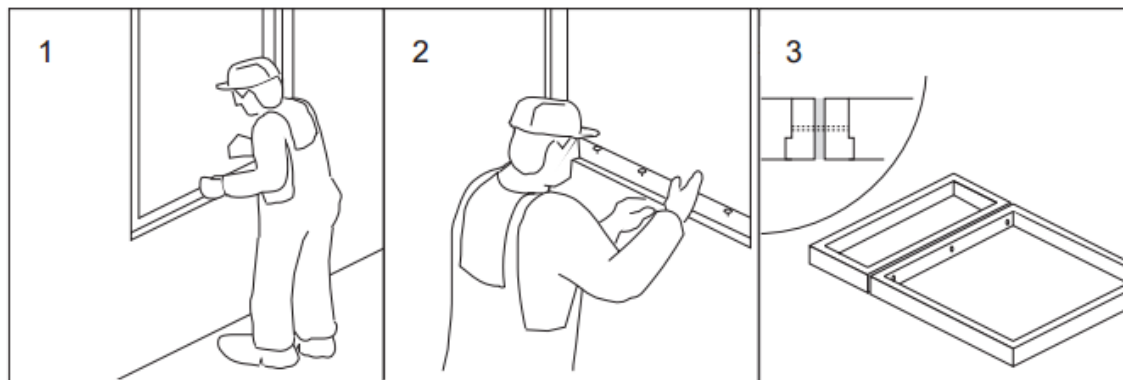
Fönsterinstallation (RT 41-10947 2009, 14).
